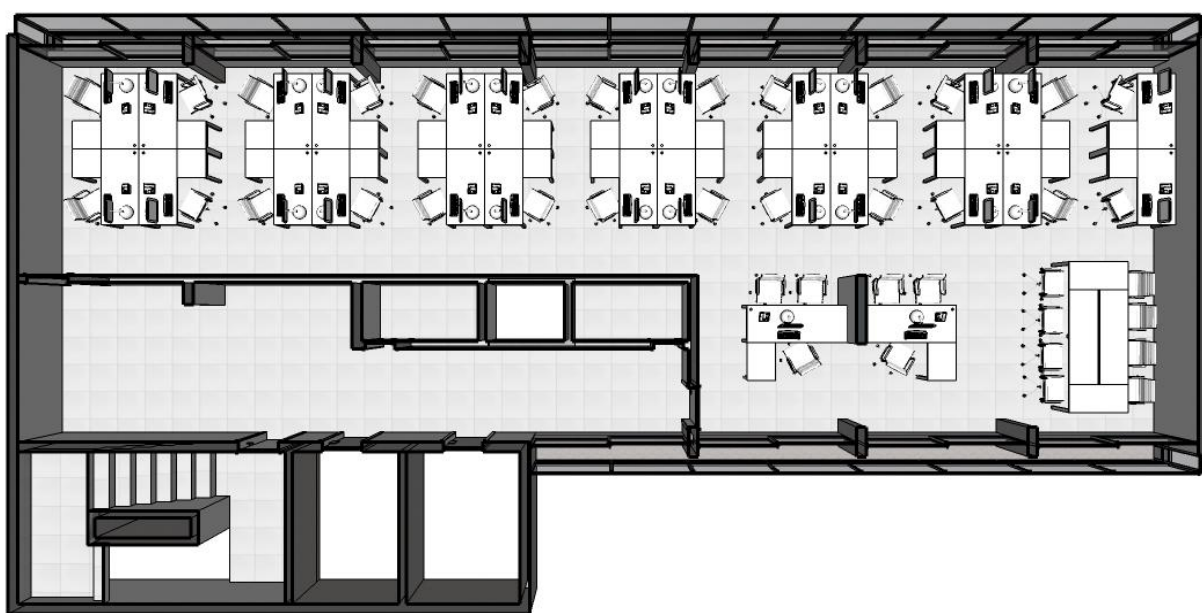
Pavimento tipo com acréscimo da fachada dupla ventilada – planta.
